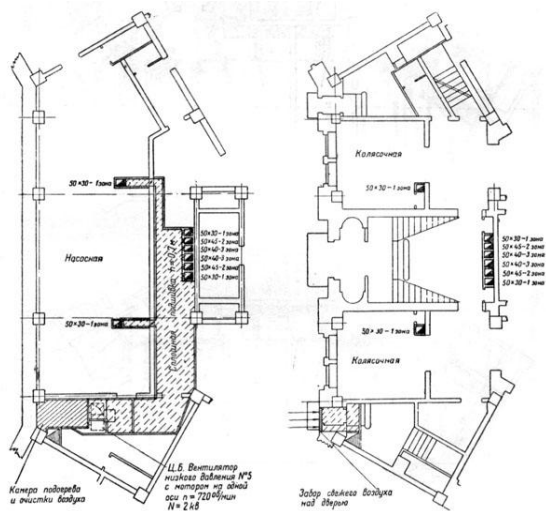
Вентиляция высотного жилого дома. Планы цокольного и 1-го этажей
